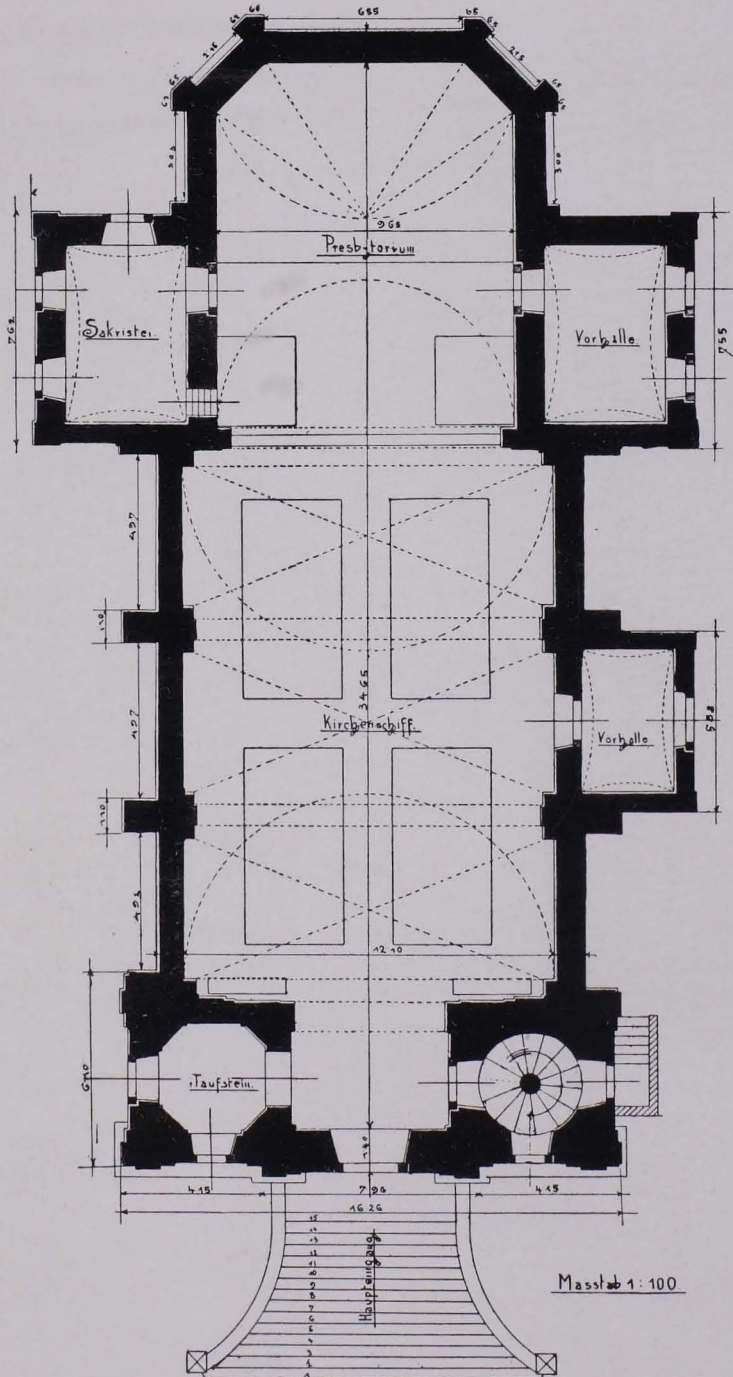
Oberleutensdorf, Kirche. Grundriß
